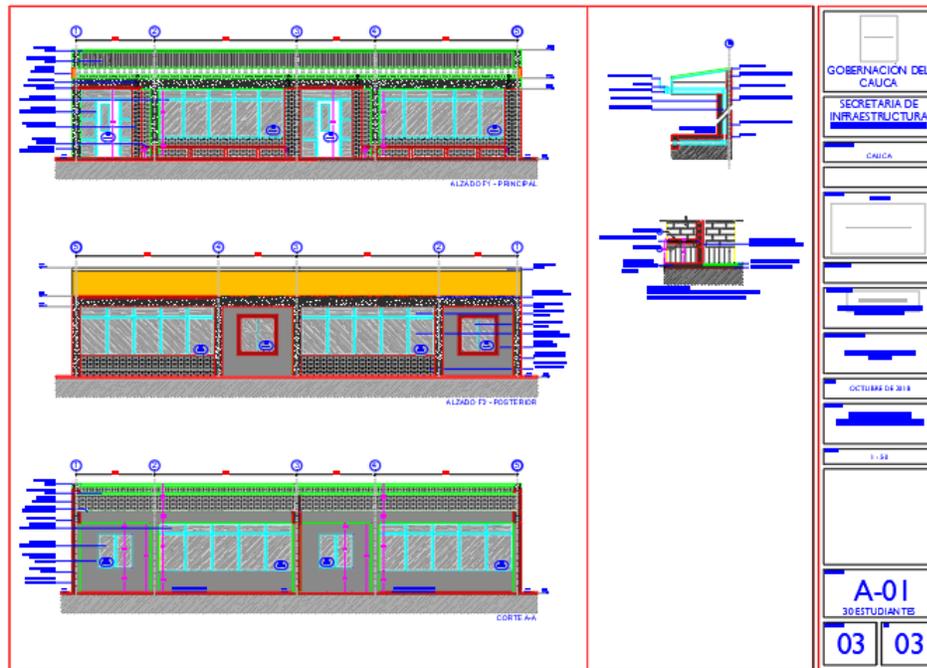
Planos arquitectónicos aulas escolares. Fuente: Arq. Juan Serrano
